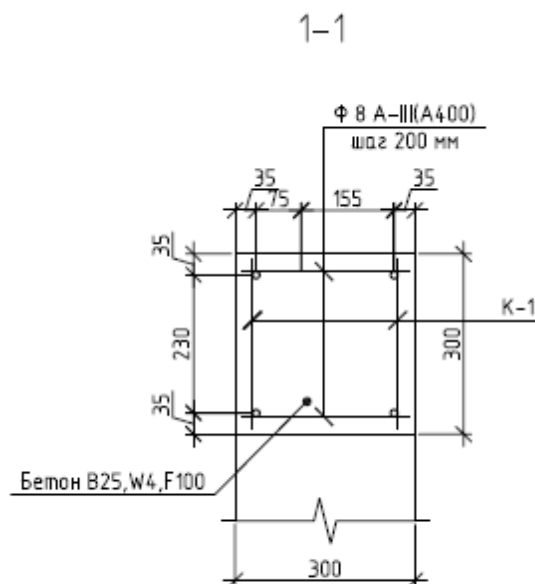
Обследование железобетонного пояса отм. верха +2.750, +7.720, +8.690
